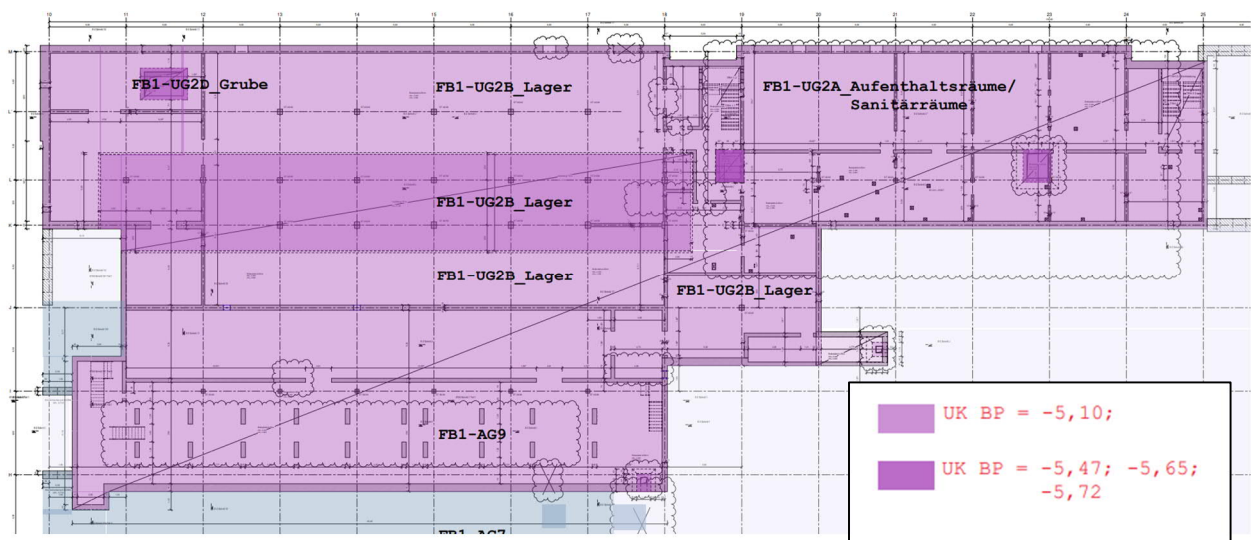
Übersicht WU-Konstruktion, Grundriss
